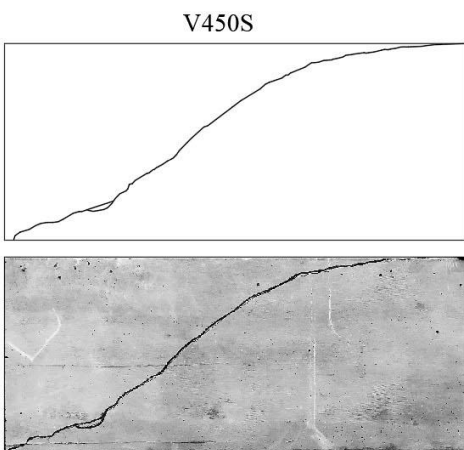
Padrão de fissuração da viga V450S.
